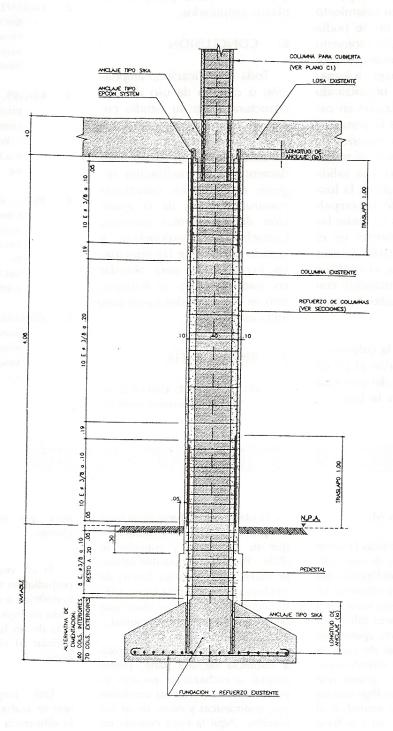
Elevación típica del refuerzo adicional para el mejoramiento sísmico a cortante de la columna.
